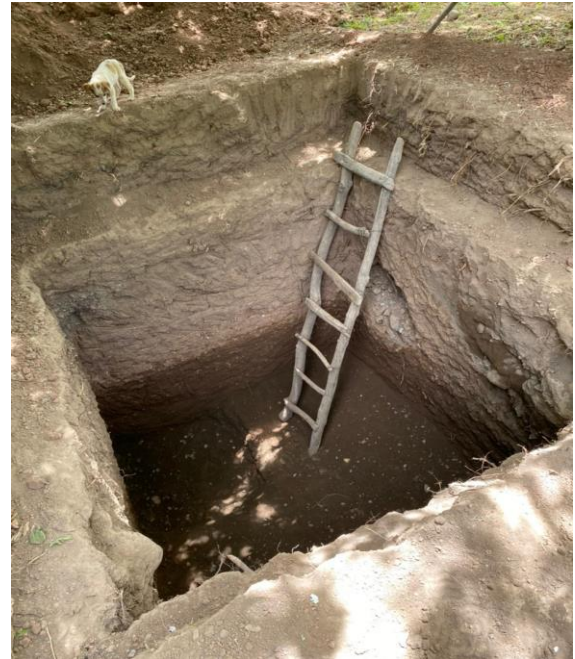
Puits perdu en cours de construction - Village Ait Oufi - Commune ASJS
